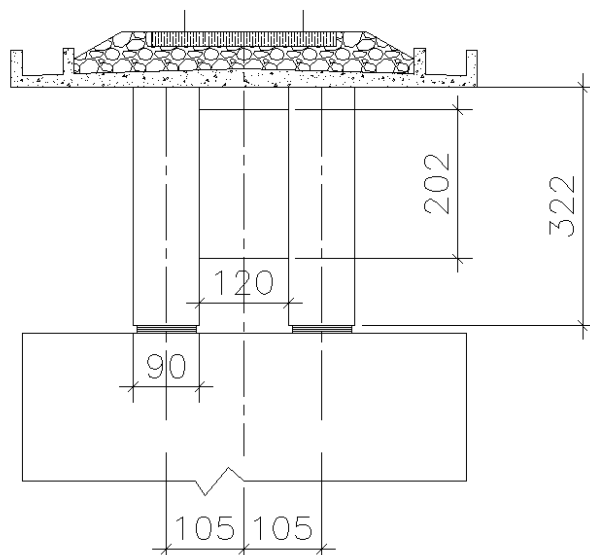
Seção Transversal no Apoio – Alternativa 1/11
